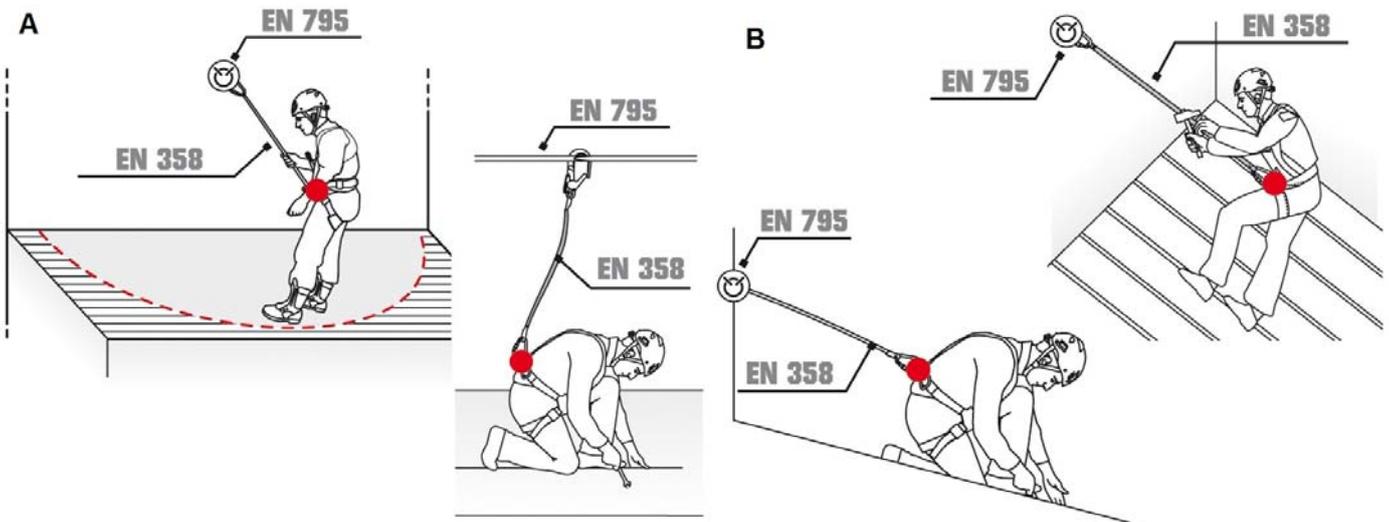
Corretto collegamento dell'imbraco (EN 358)
